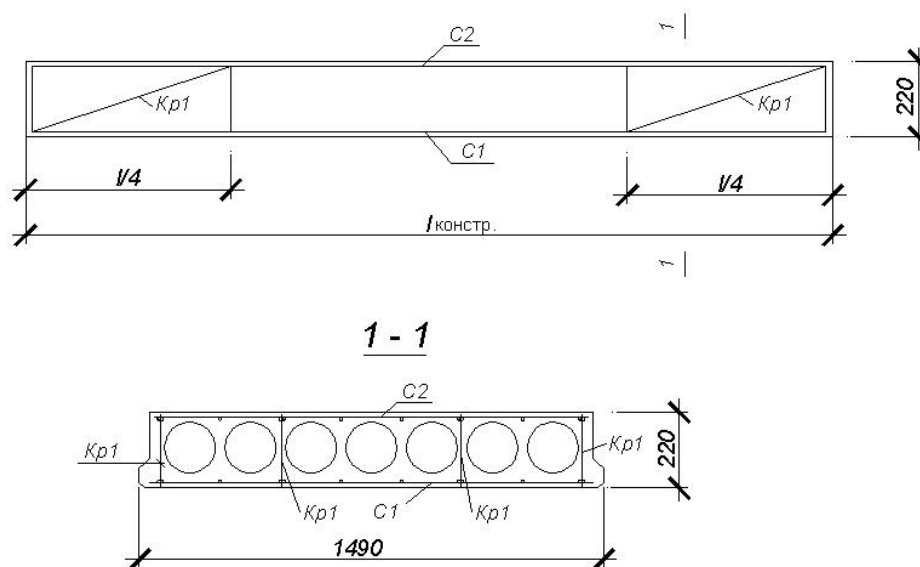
Приклад армування плити перекриття з круглими порожнинами
